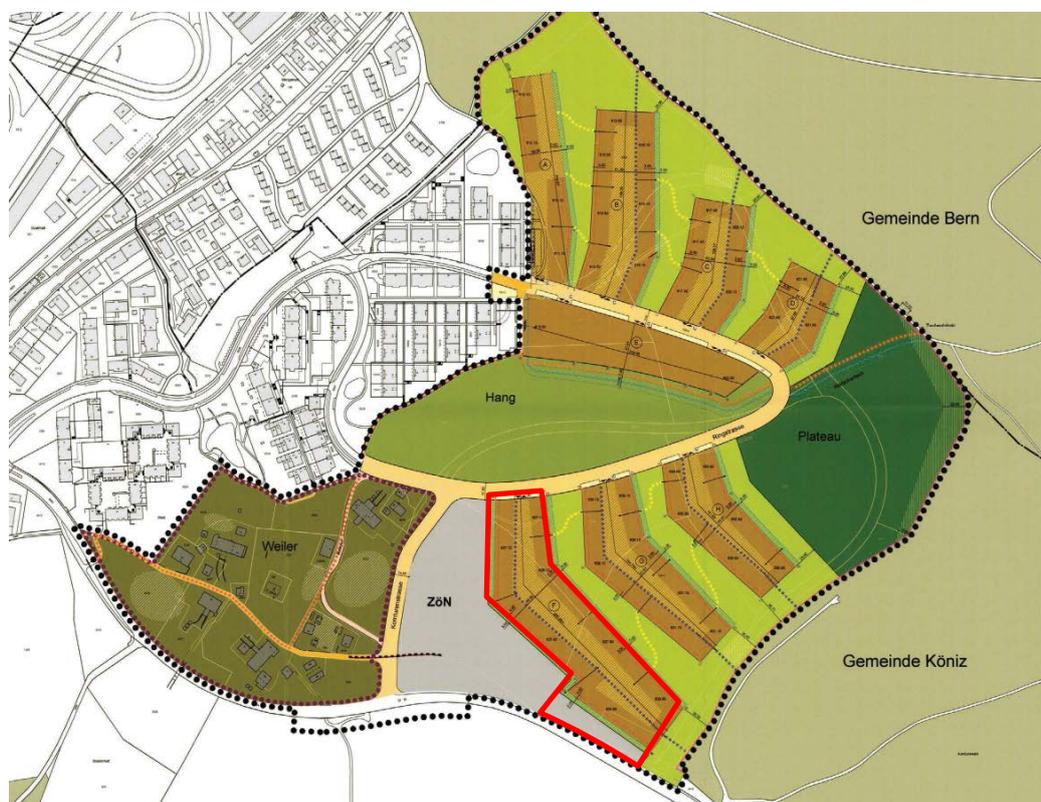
Projekt- und Betrachtungssperimeter (Quelle: UeO)
